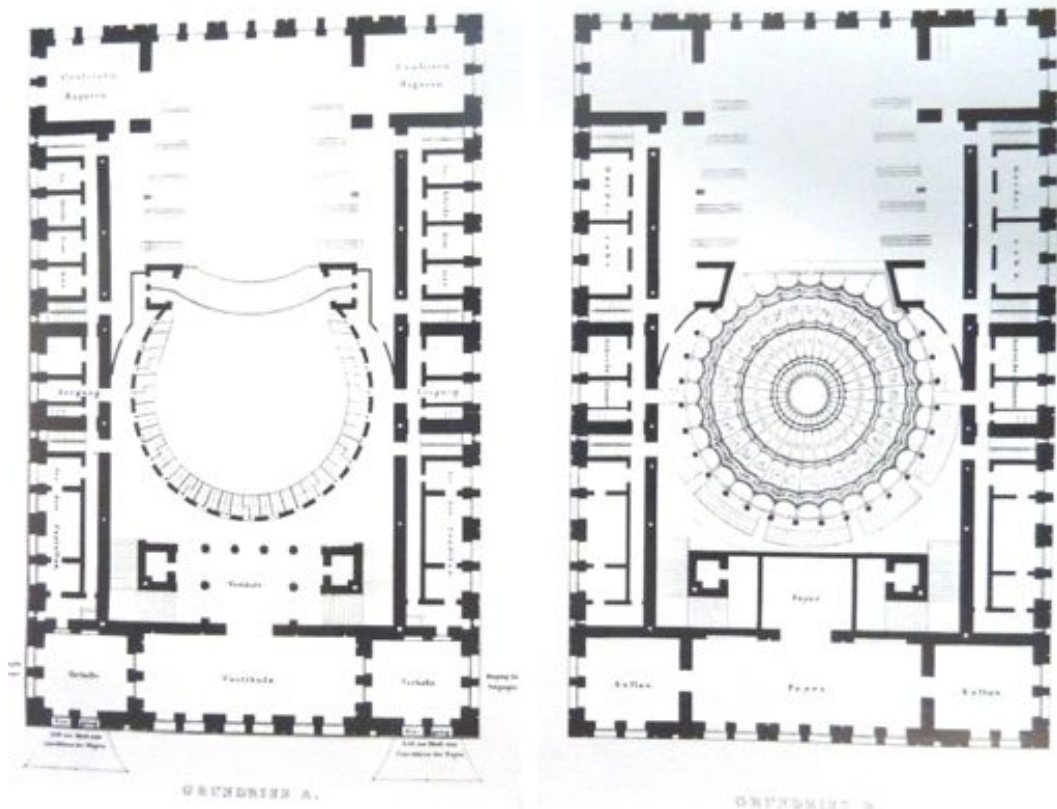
Friedrich Schinkel, Entwurf für ein Hamburger Schauspielhaus, Grundrisse.
